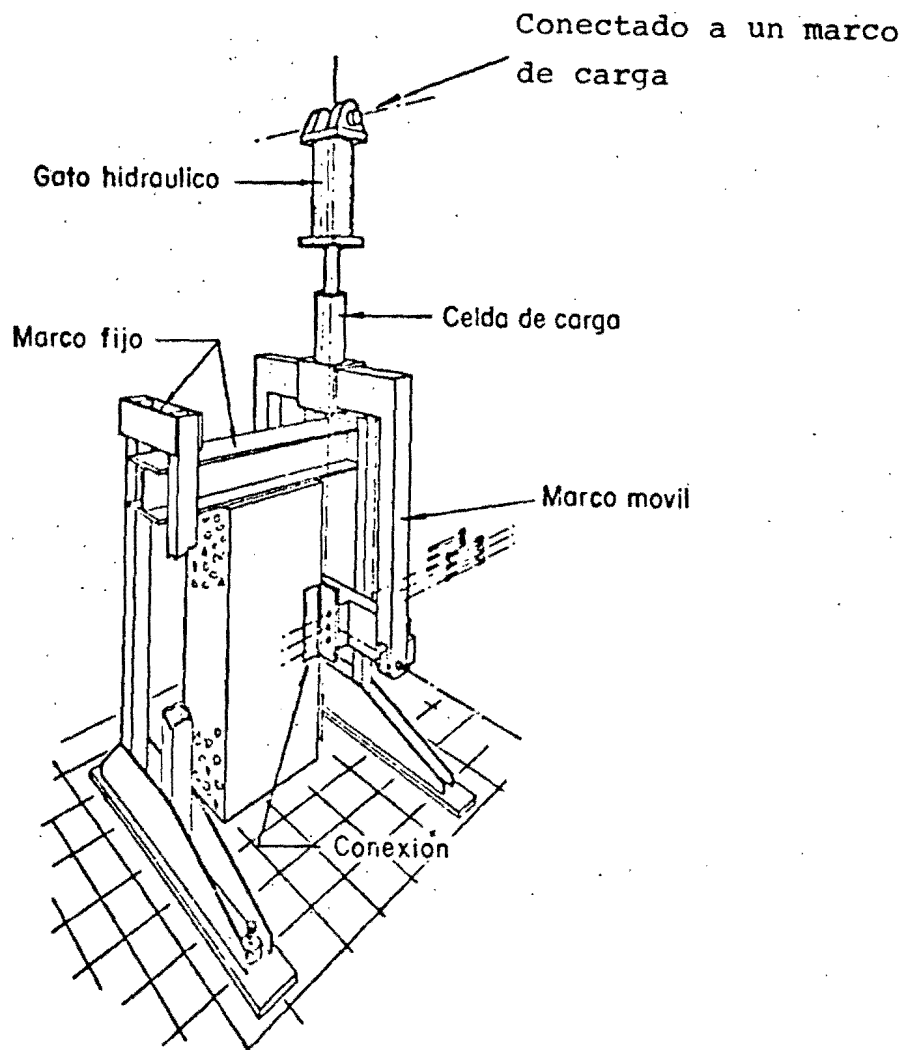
Sistema de ensaye para conexiones soldadas reportado en la ref 52
